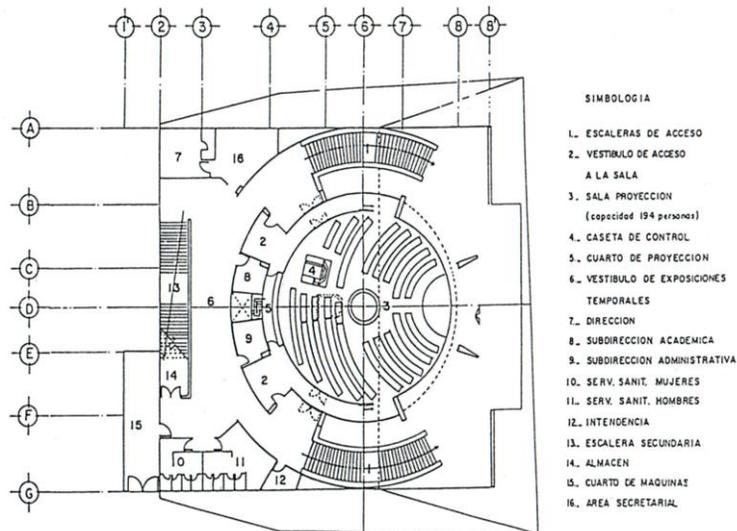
Planta primer nivel planetario de Ciudad Victoria
